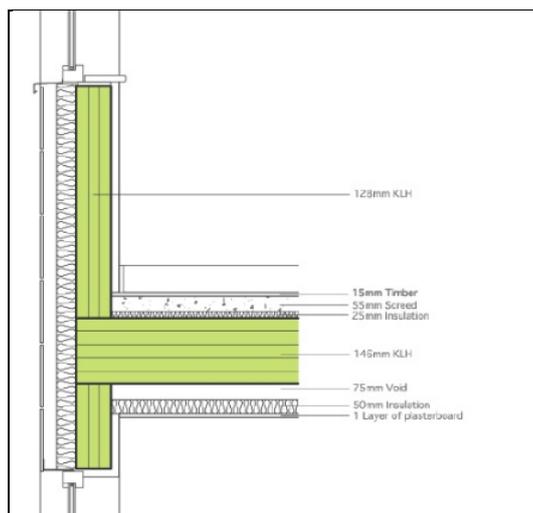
Composição transversal do pavimento (LIDDELL, 2013)
